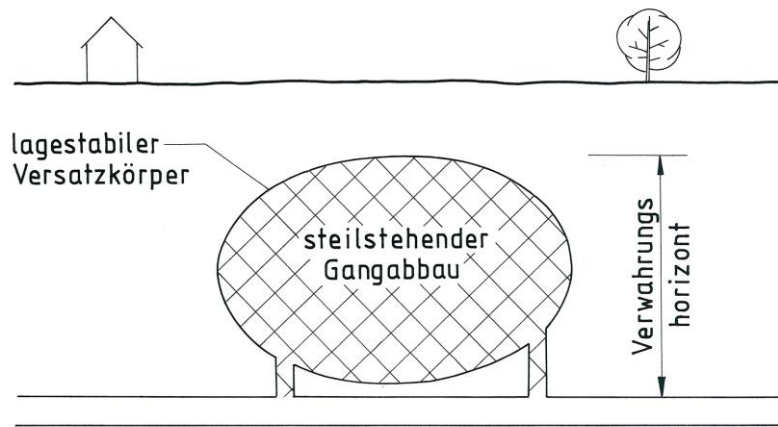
Schema zum Einbau eines lagestabilen Versatzkörpers in einem Gangabbau
